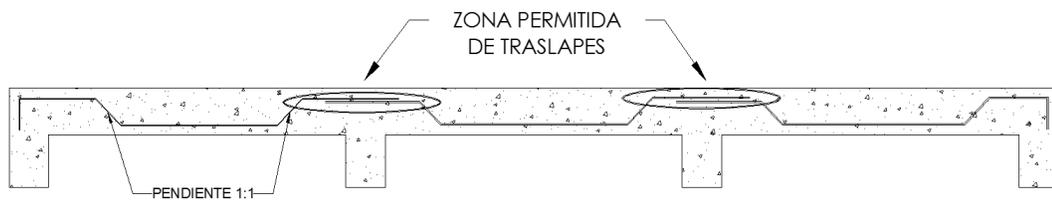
Colocación de acero de refuerzo en losa densa según caso 2
